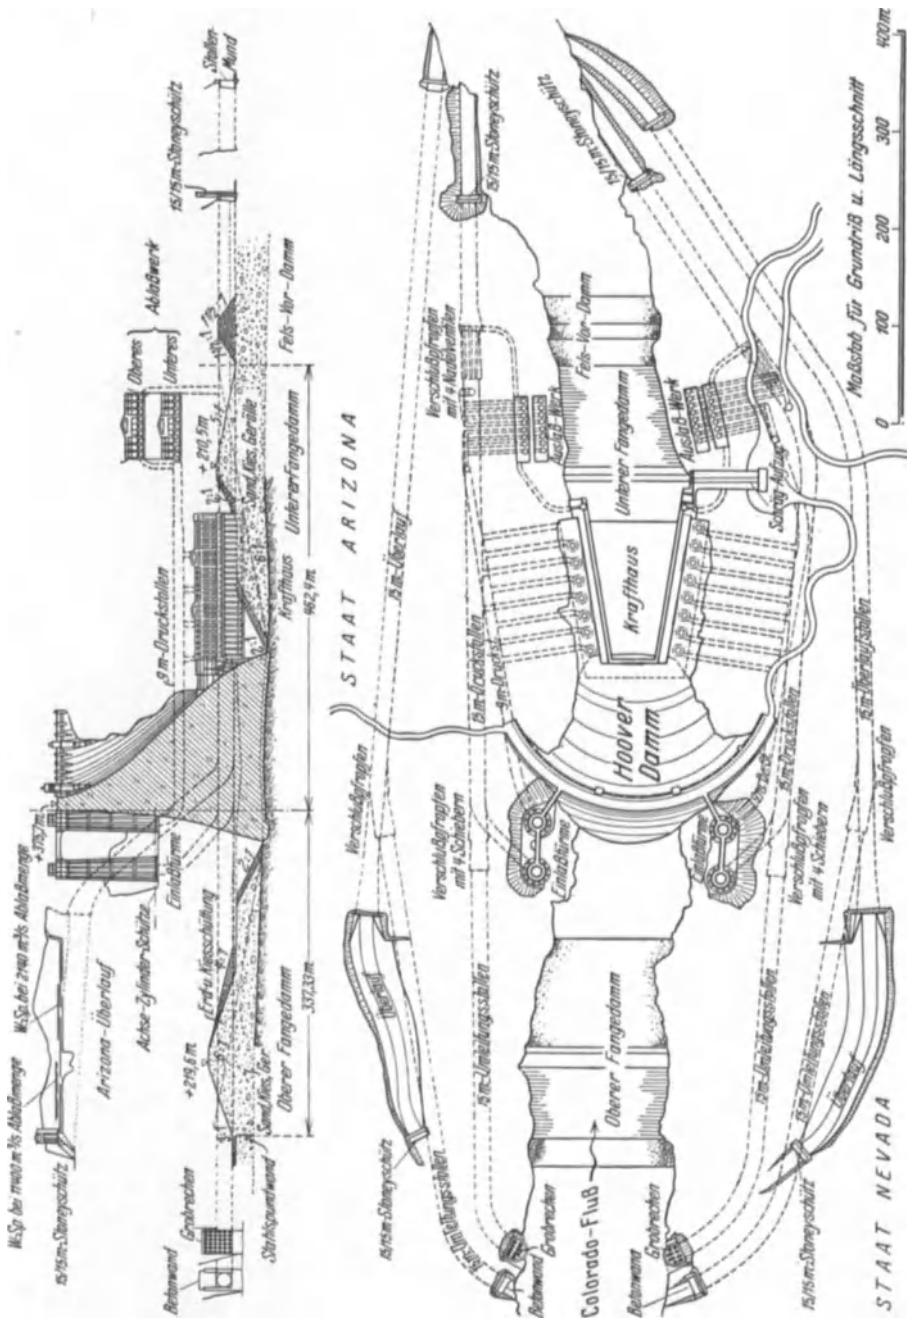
Hooversperre, Grundriß und Längsschnitt. (Verw. 1932.)
